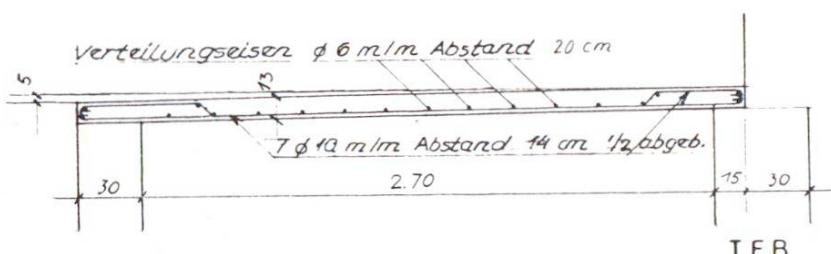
Abdeckung der Jauchegrube mit einer Eisenbetonplatte
